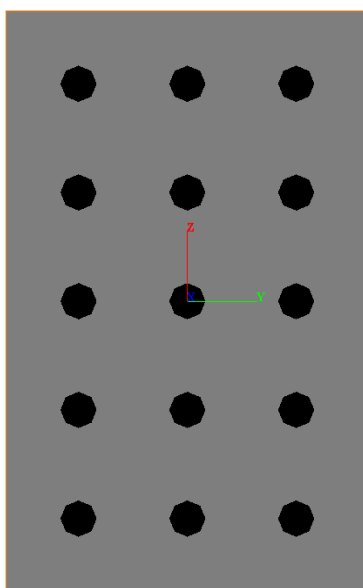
Vista planimetrica del modello GROUPv2016.
